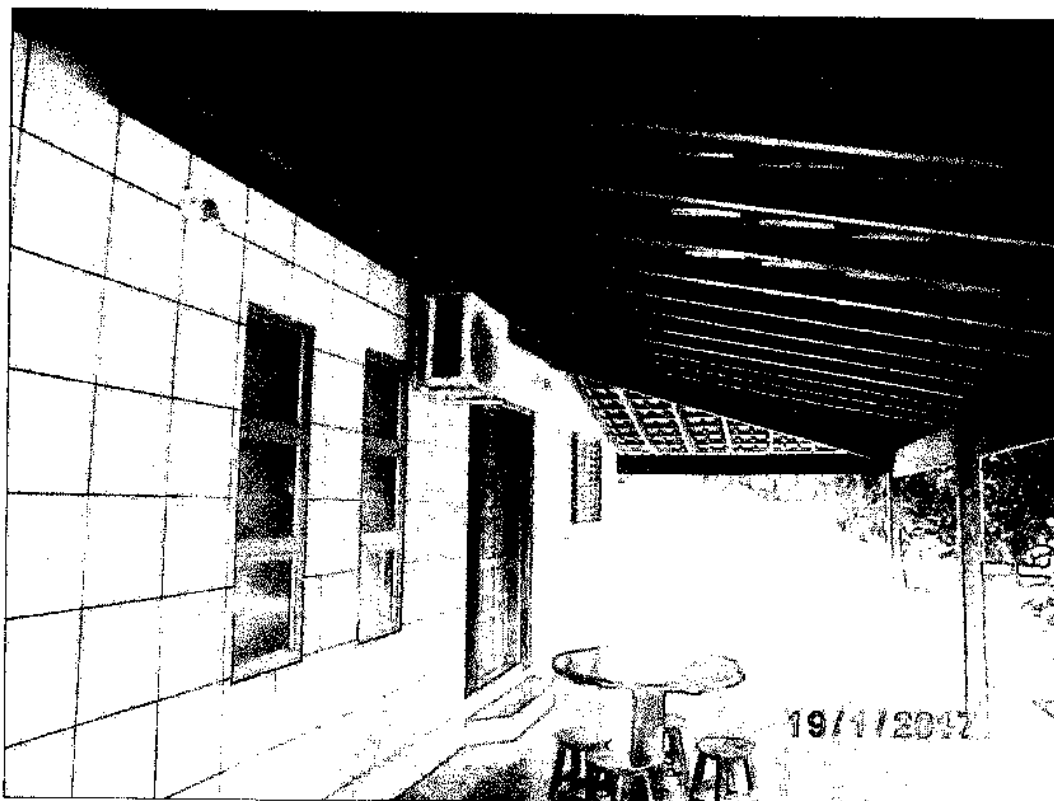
MESMO LOCAL, DE OUTRO ANGULO
